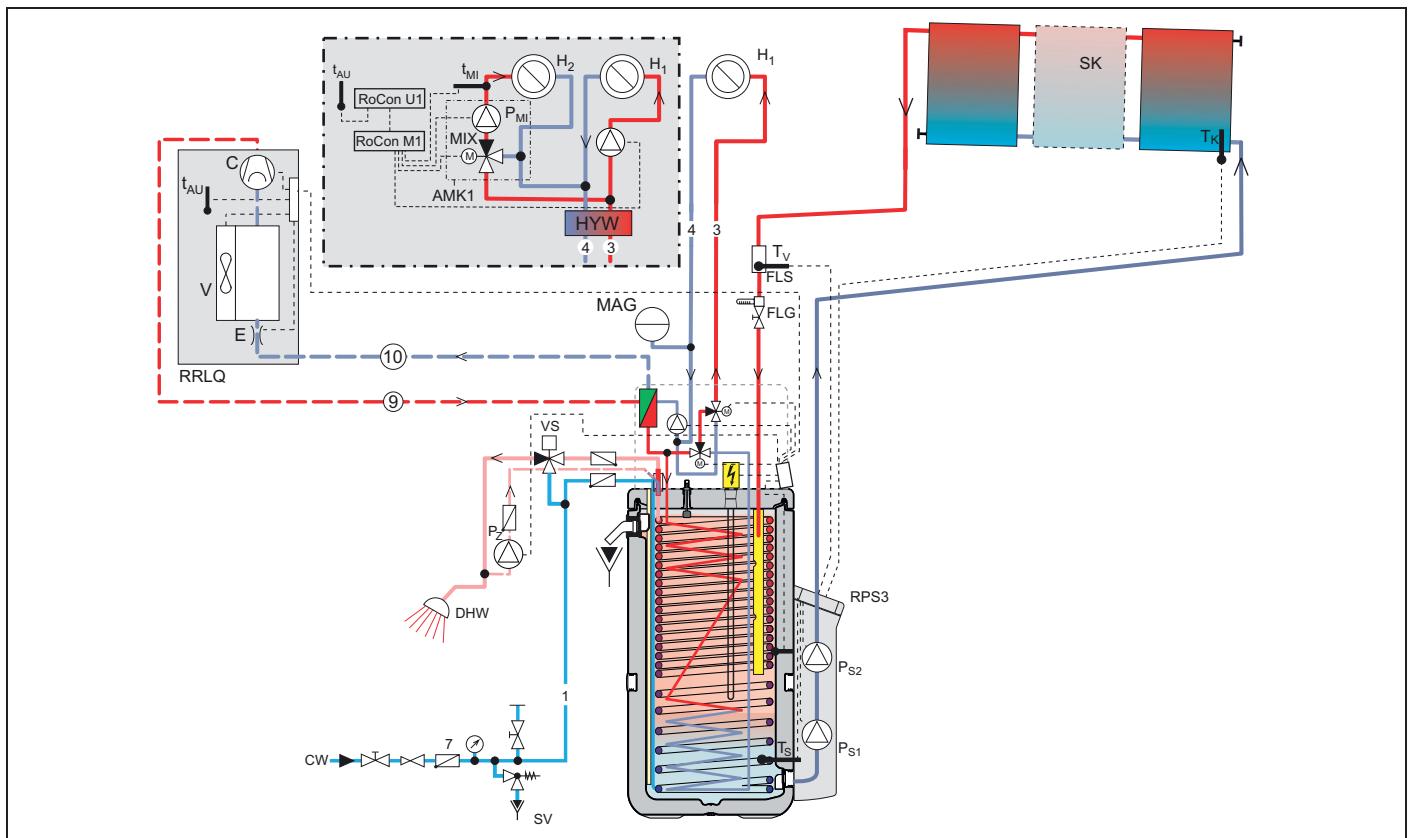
HPSU compact (alle Typen) mit DrainBack Solaranlage - Standardvariante
